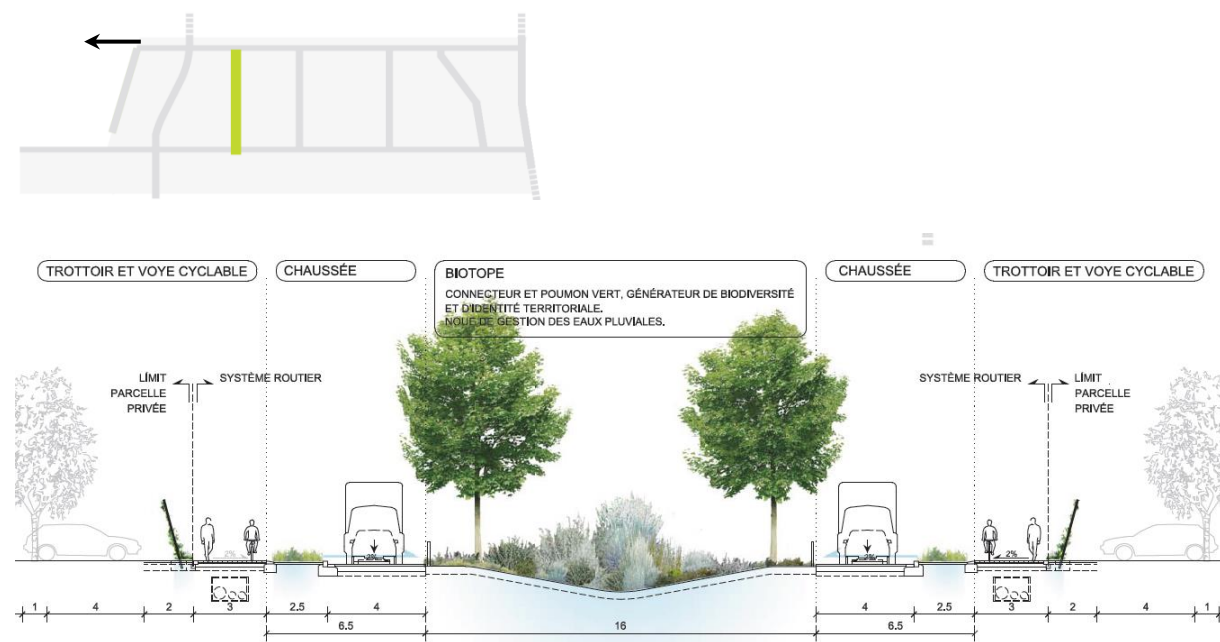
Coupe de principe de la rue de Balmes (Extrait plan guide BAU juin 2016)
